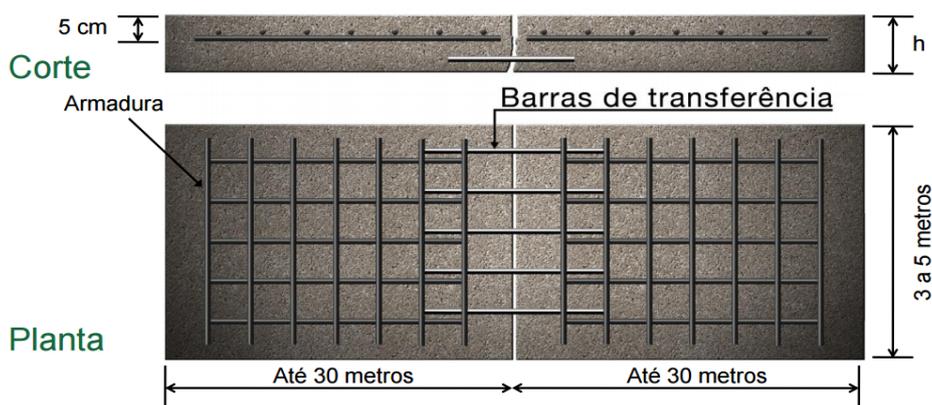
Pavimentos de concreto com armadura distribuída descontínua
